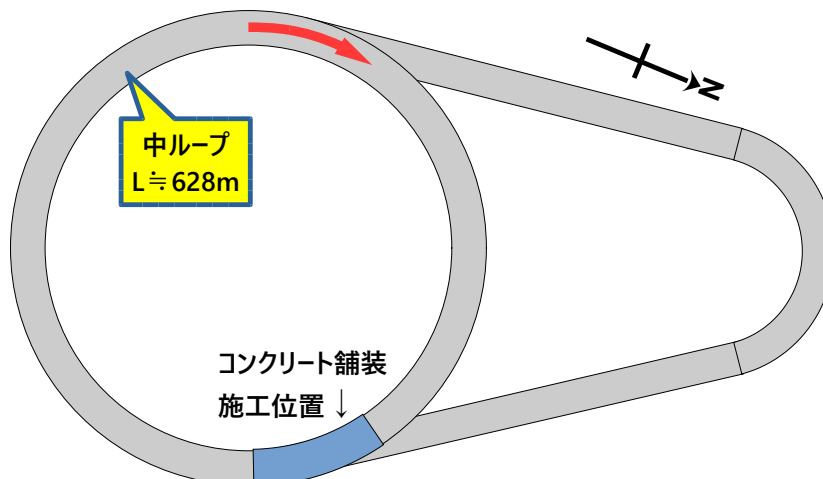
舗装走行実験場におけるコンクリート舗装の施工位置
